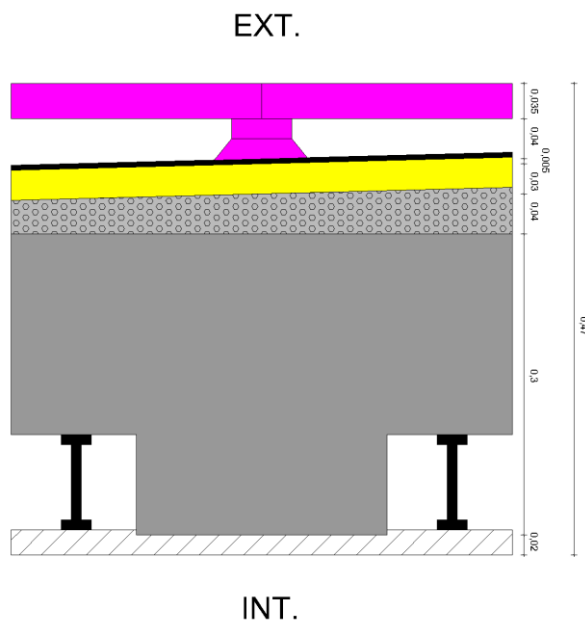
Ponte térmica plana de vigas em pavimento interior sobre a cave – PavENU1ptp1
